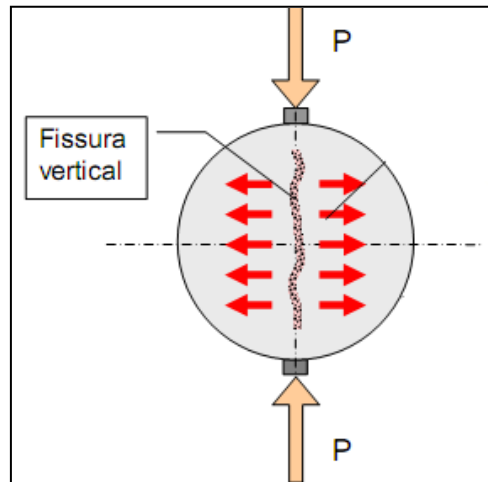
Esquema do ensaio de compressão diametral com fissura vertical. [13]
